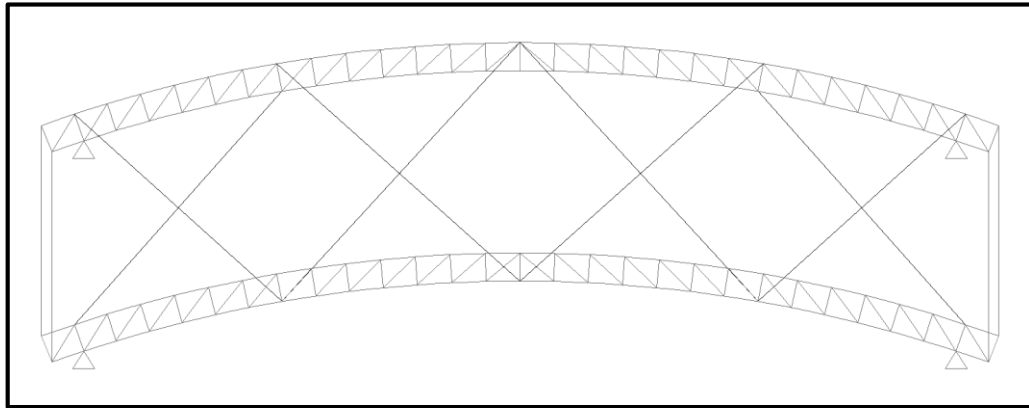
Arriostramientos de techo, vista entre armaduras
